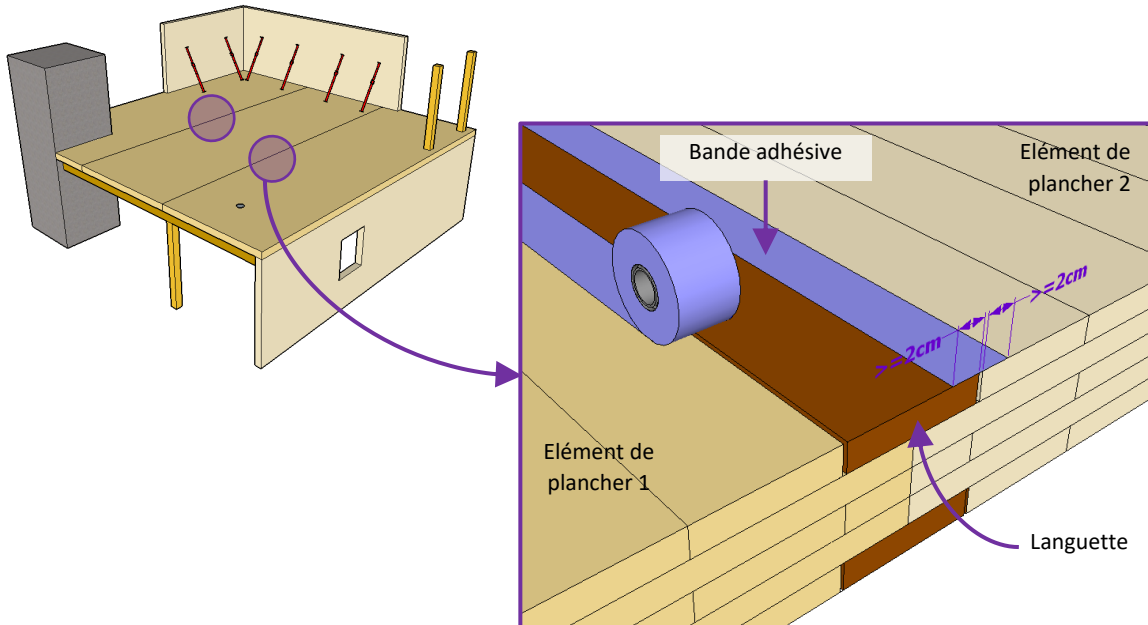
Exemple de protection pour une jonction entre deux planchers CLT assemblés avec languette rapportée
